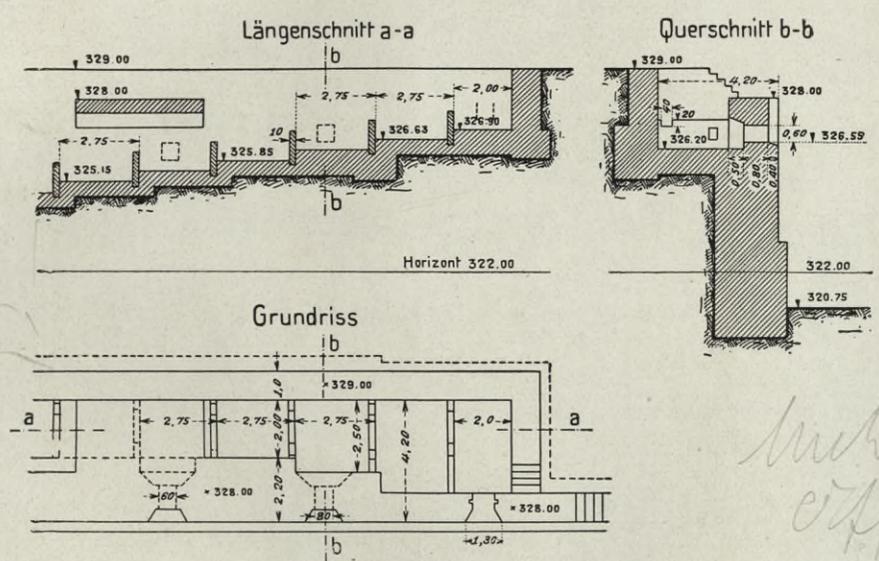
Stauwehr des Elektrizitätswerkes Beznau. Grundriss und Schnitte durch die Fischtrappe. Maßstab 1:250.
